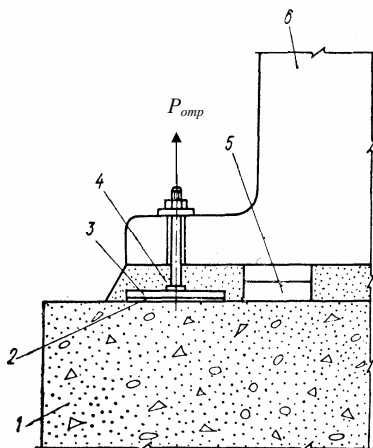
Схема безанкерного способа крепления оборудования на готовых фундаментах: 1 – фундамент; 2 – клеевой слой; 3 – узел крепления; 4 – подливка; 5 – монтажные подкладки; 6 – оборудование торцам призмы акриловым клеем. Площадь приклейки $F_{кл} = F_{пл} = 49 \text{ см}^2$.
